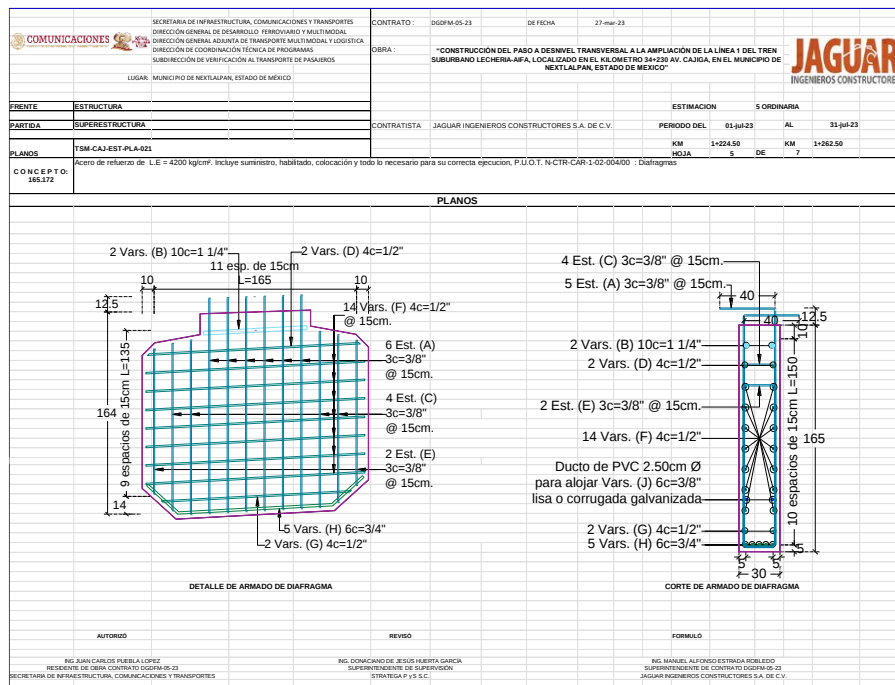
NOTA: Adaptado de Diafragma claro 02, Autoría Propia, 2023
